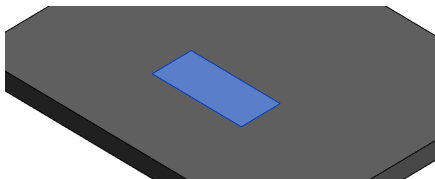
Моделирование дефекта «Скол бетона с оголением и коррозией продольной арматуры»
